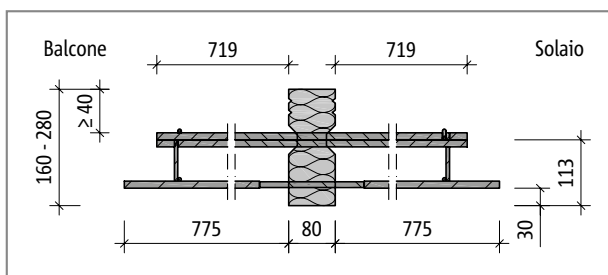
Schöck Isokorb® tipo EQM: sezione dell'elemento
